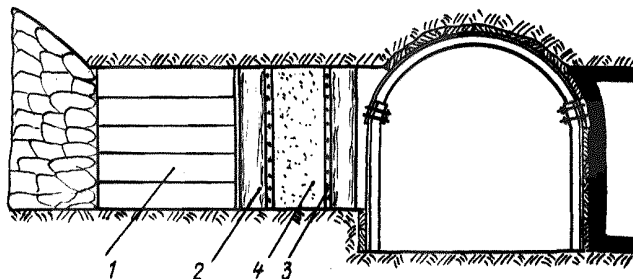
Изолирующая стенка из пенопласта при охране выработки железобетонными тумбами:
